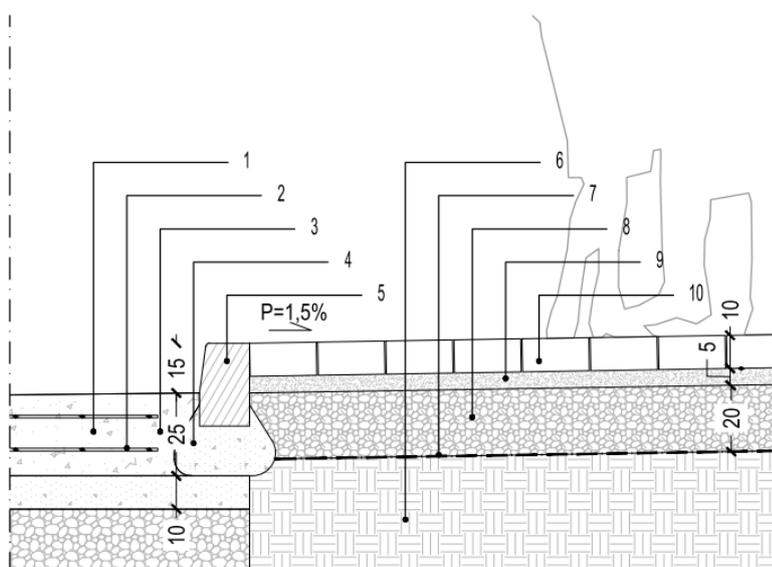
pavimentazione stradale: strato di usura in conglomerato bituminoso, sp. 4 cm
